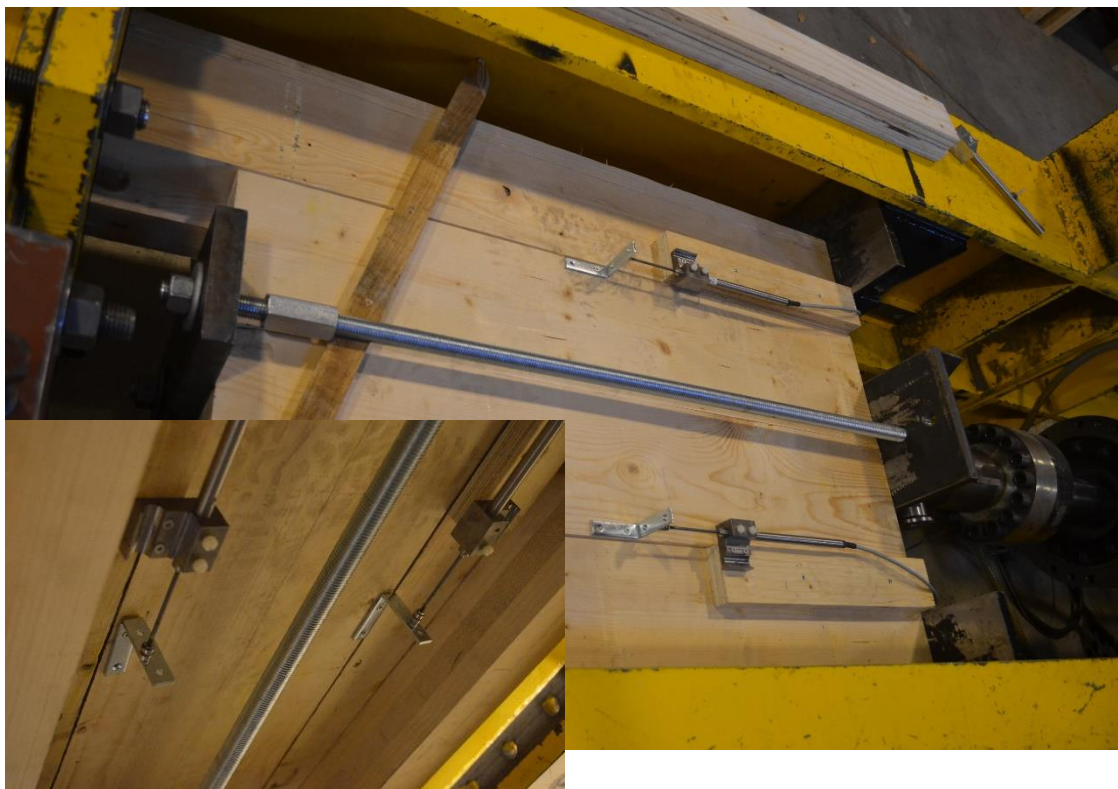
Montage des essais alternés de coutureage de panneaux GLT
